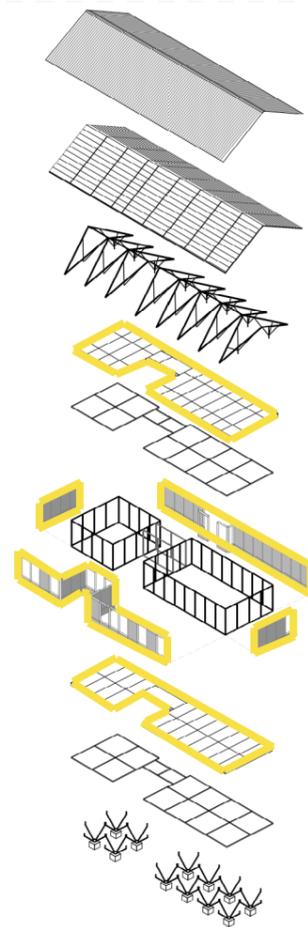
Elementos de envolventes. Fuente: Autoría propia
